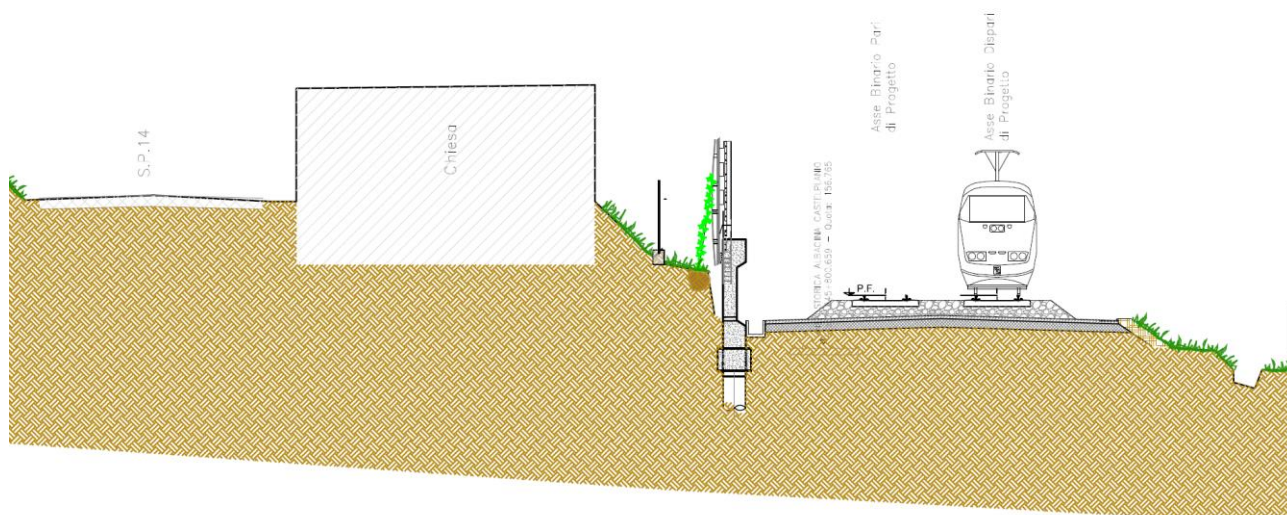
TIPOLOGICO BARRIERA STANDARD– SEZIONE CON RAMPICANTE
